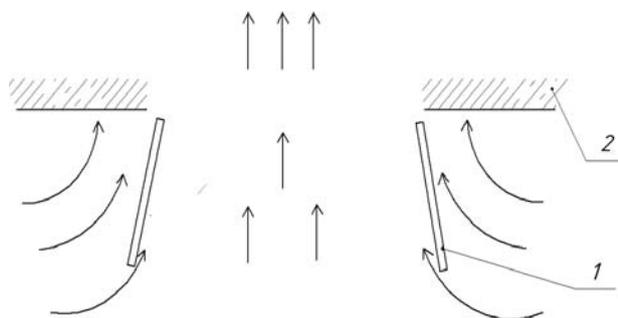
Принципиальная схема натекания воздуха при открытых под углом распашных воротах: 1 – полотно ворот; 2 – стена здания
